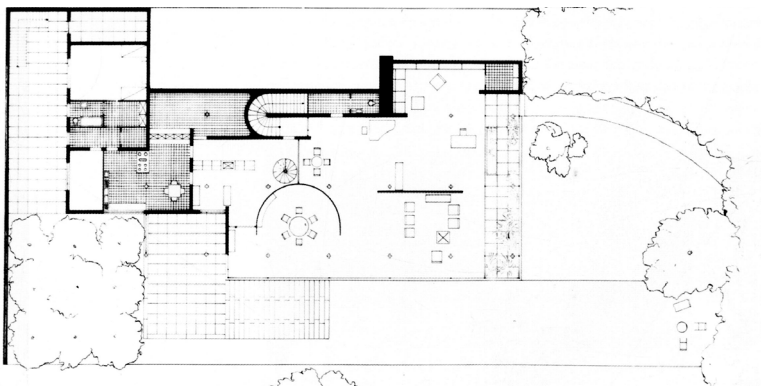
Villa Tugendhat. Plano de la planta del primer sótano o planta noble.
